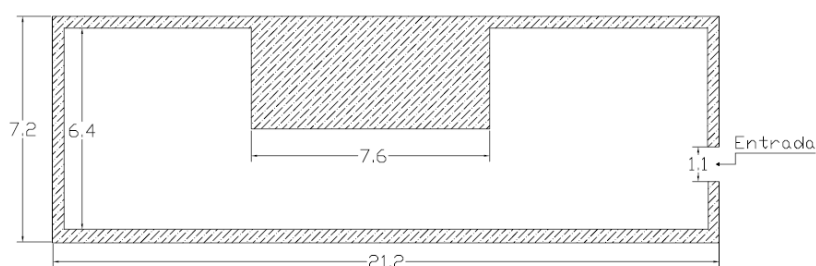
Planta esquemática da sala de espera e bilheteira (dimensões em metros)
